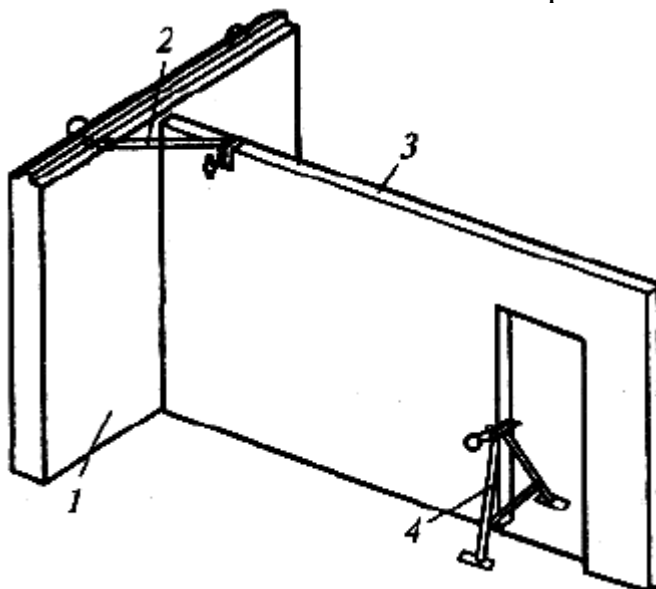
Схема временного крепления панели внутренней стены с помощью монтажной связи и монтажной опоры: 1 - панель наружной стены; 2 - монтажная связь; 3 - панель внутренней стены; 4 - монтажная опора
